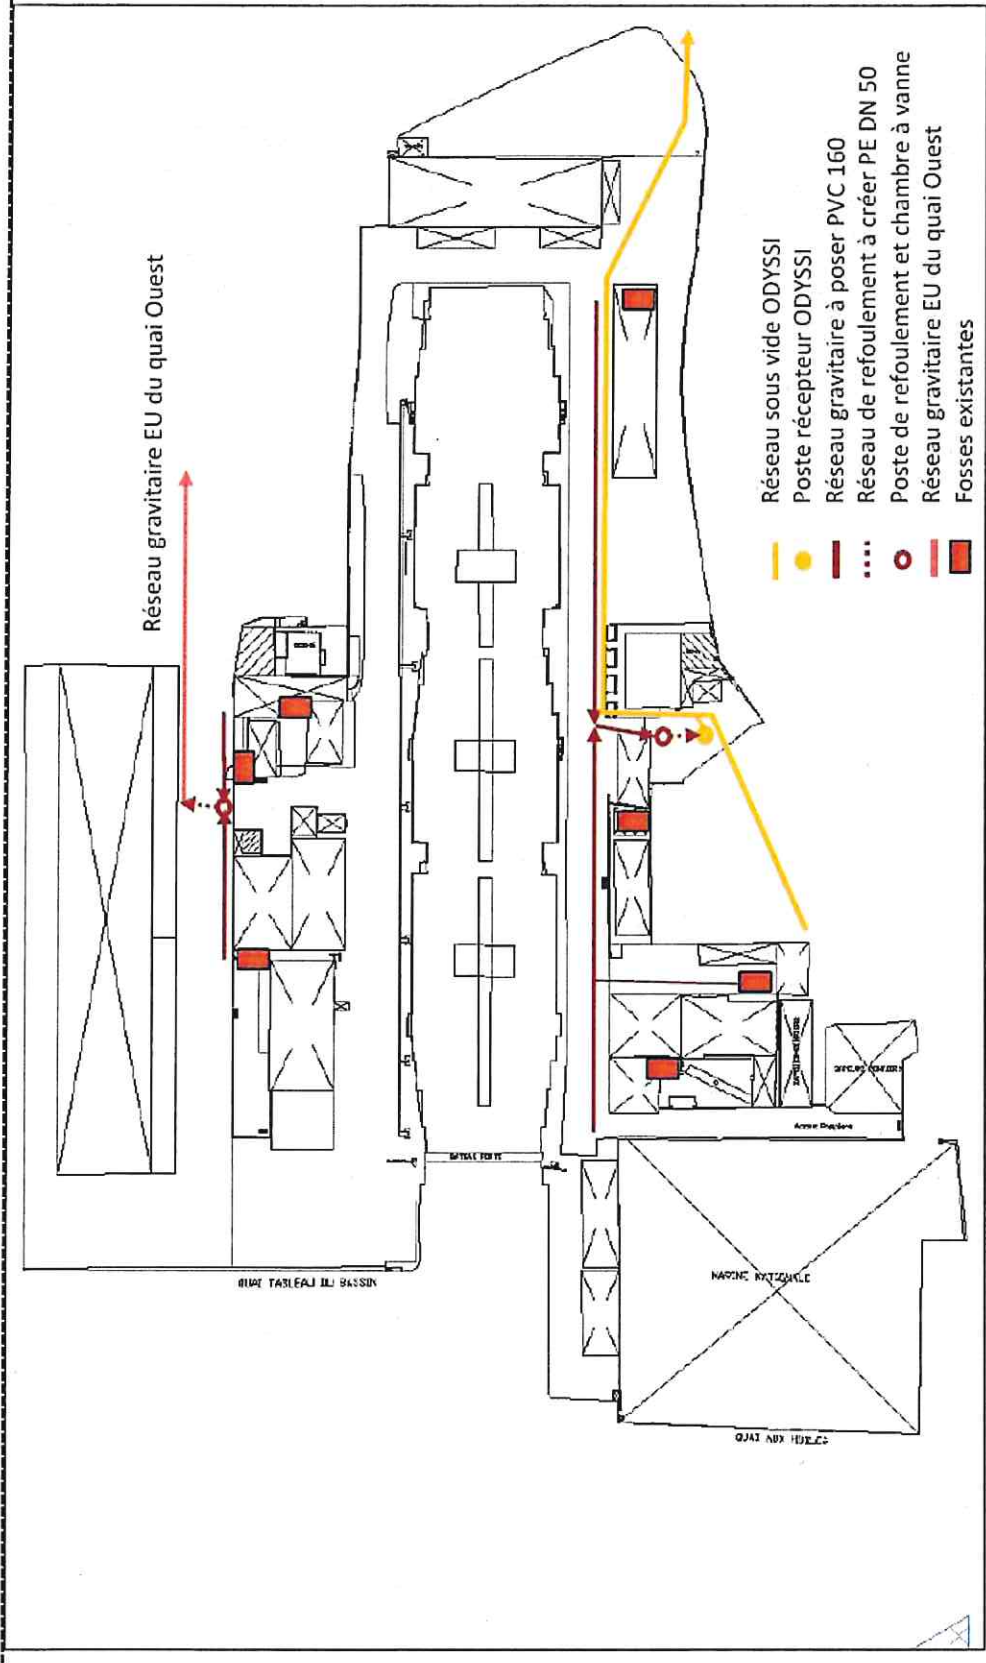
Plan projet de la configuration du réseau eaux usées domestiques sur le bassin de Radoub
